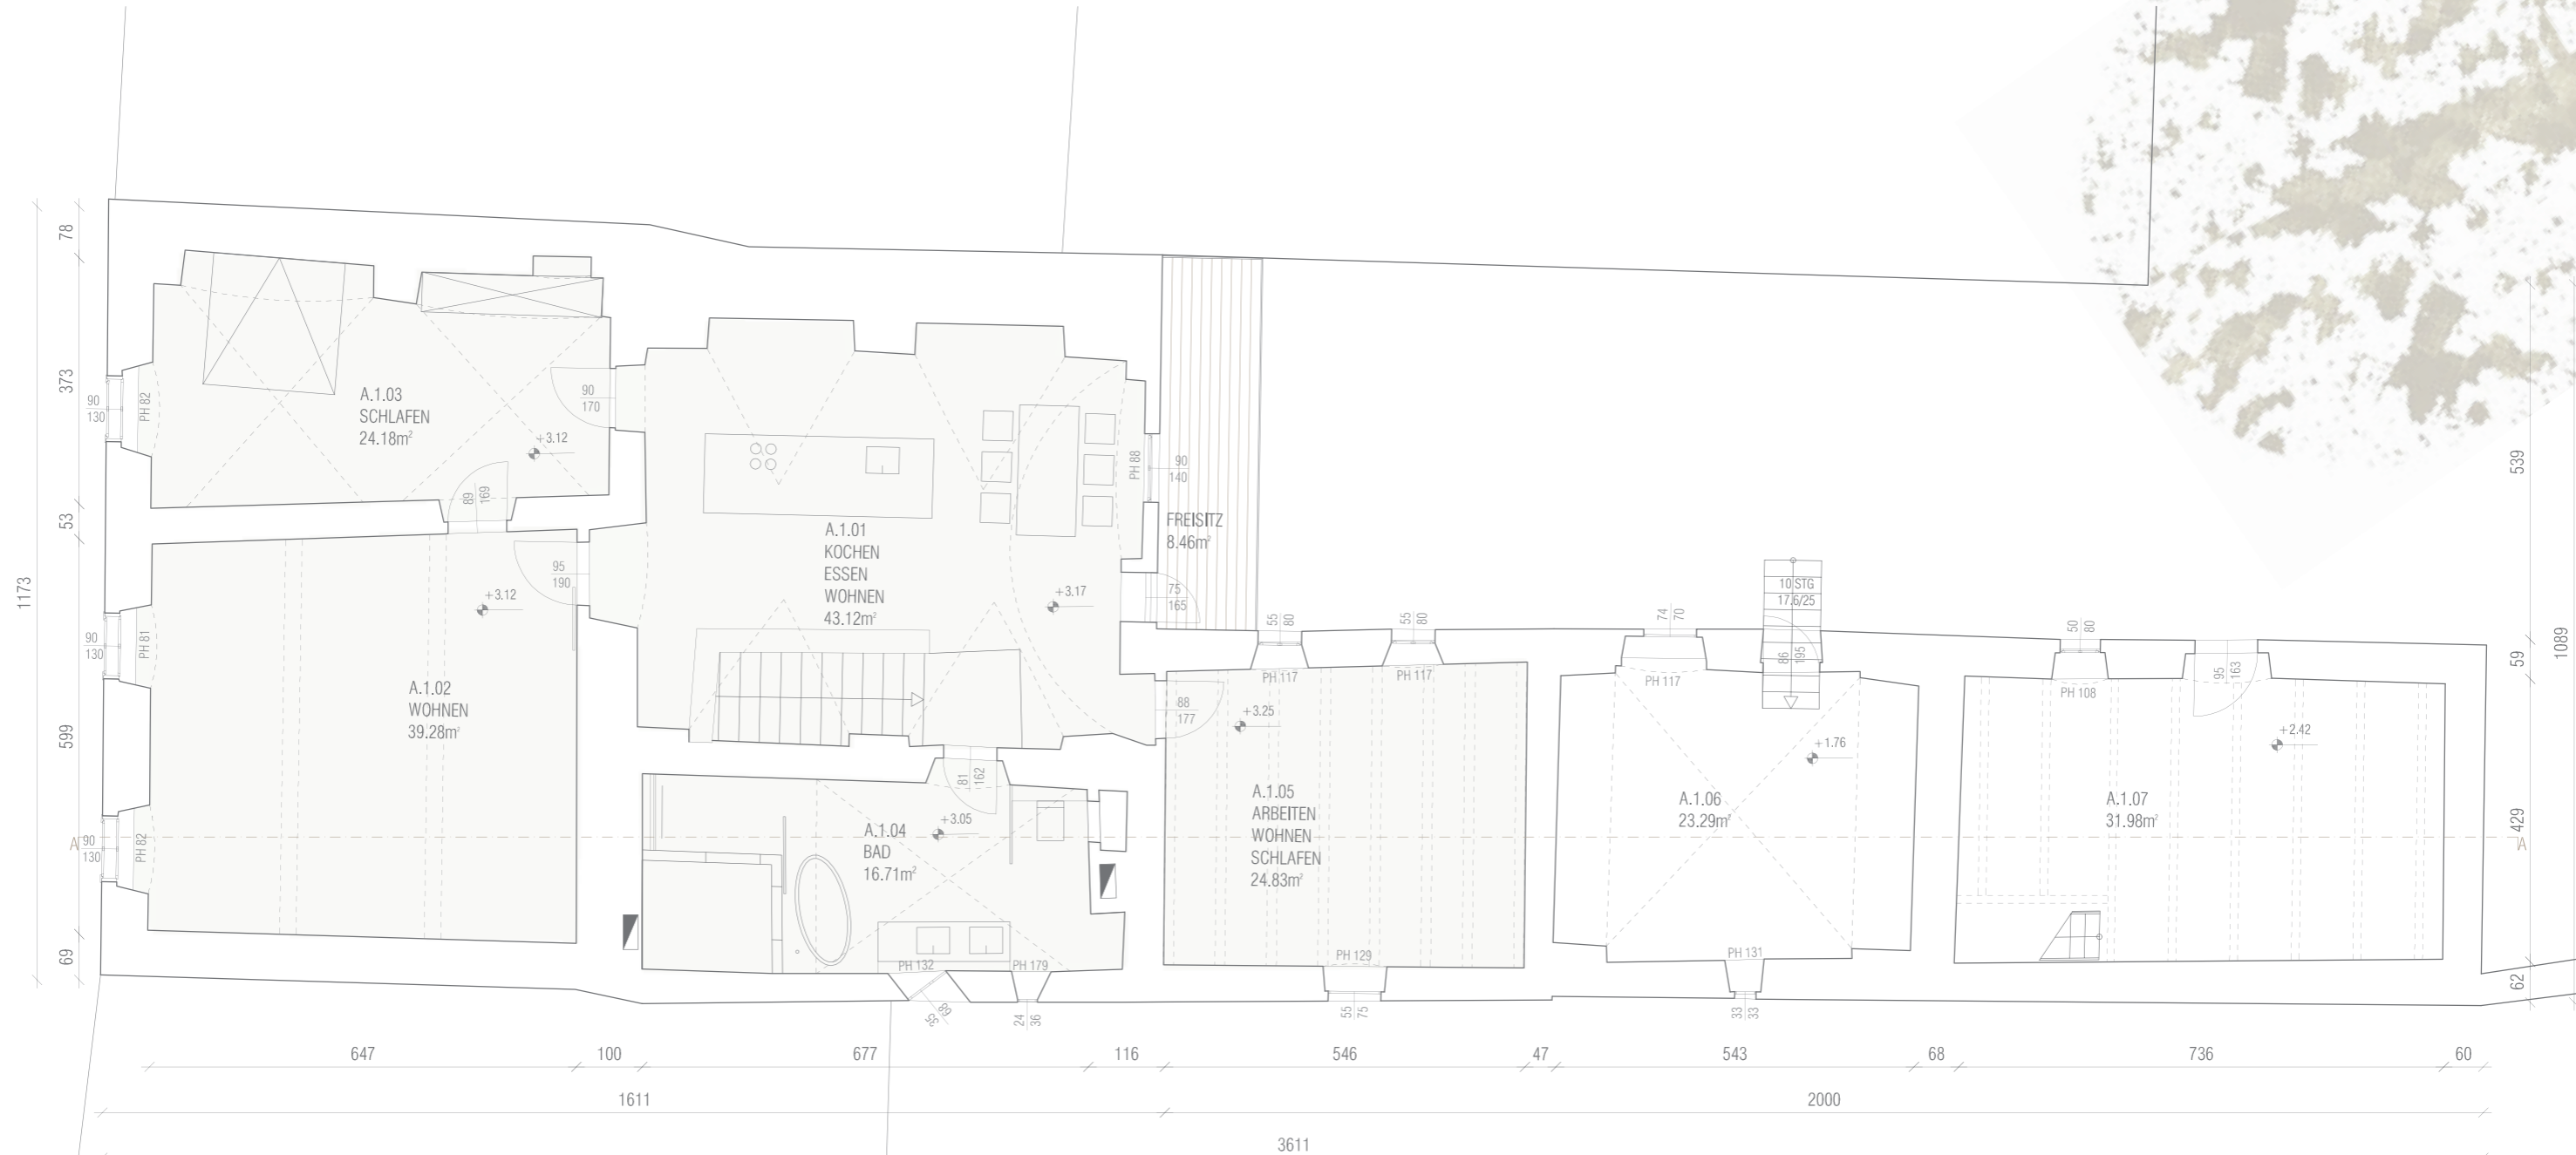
Gebäude A_STARTHAUS_Grundriss Obergeschoss Maßstab 1:100
